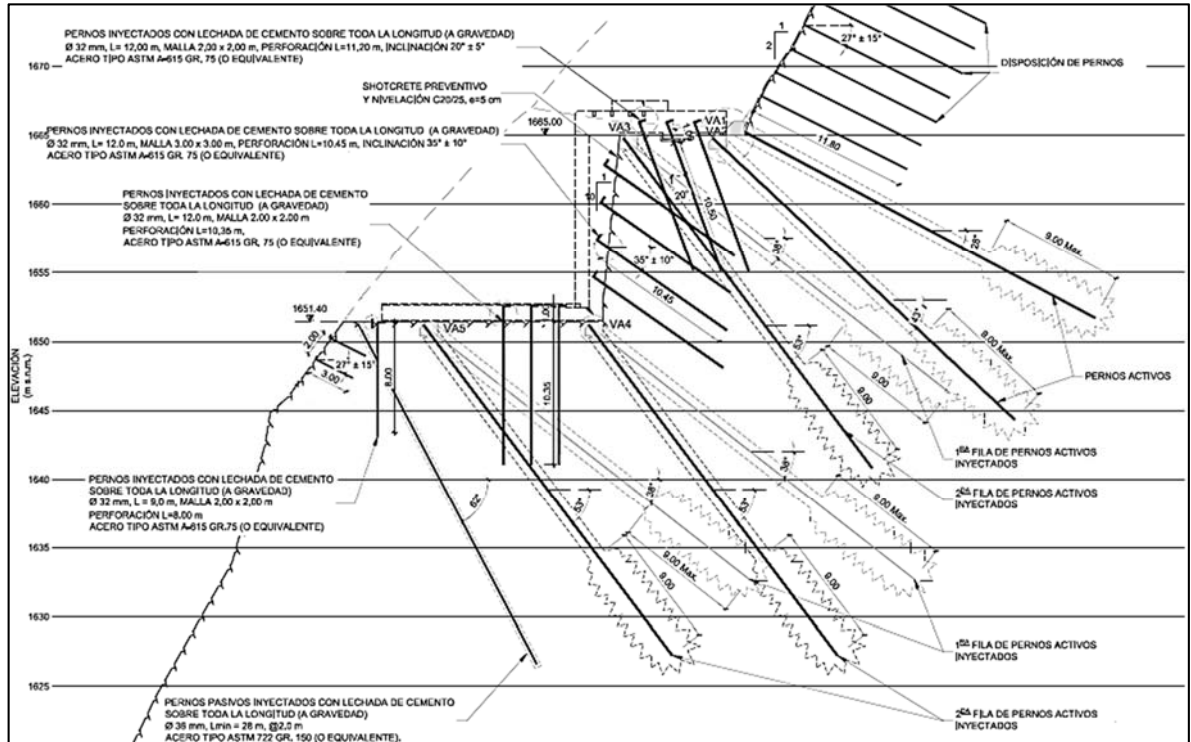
Plano de elevación. (Fuente CRM-CHCDA modificada por el autor de la presente tesis).
